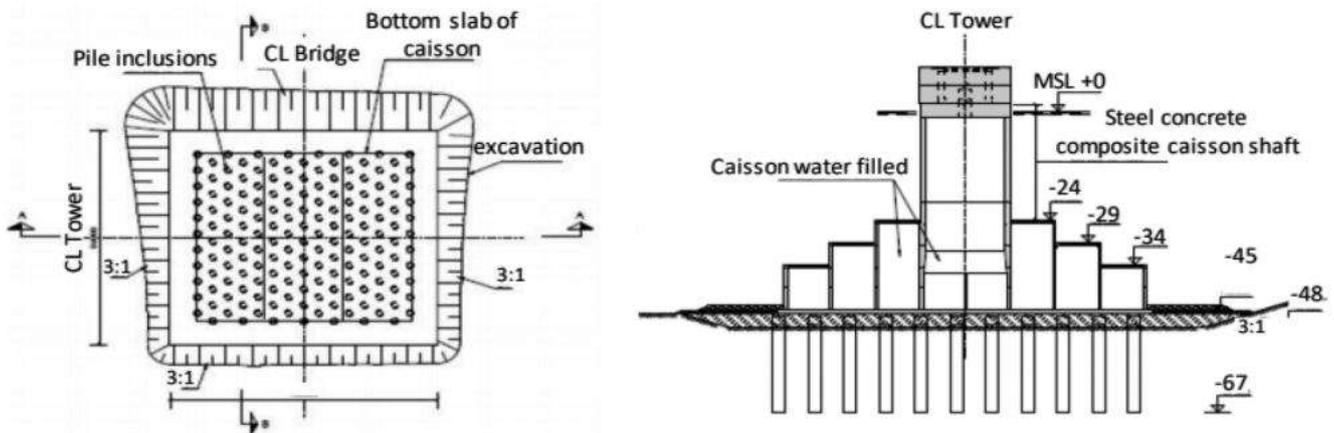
Fondazioni del «1915 Çanakkale Bridge» [58].
